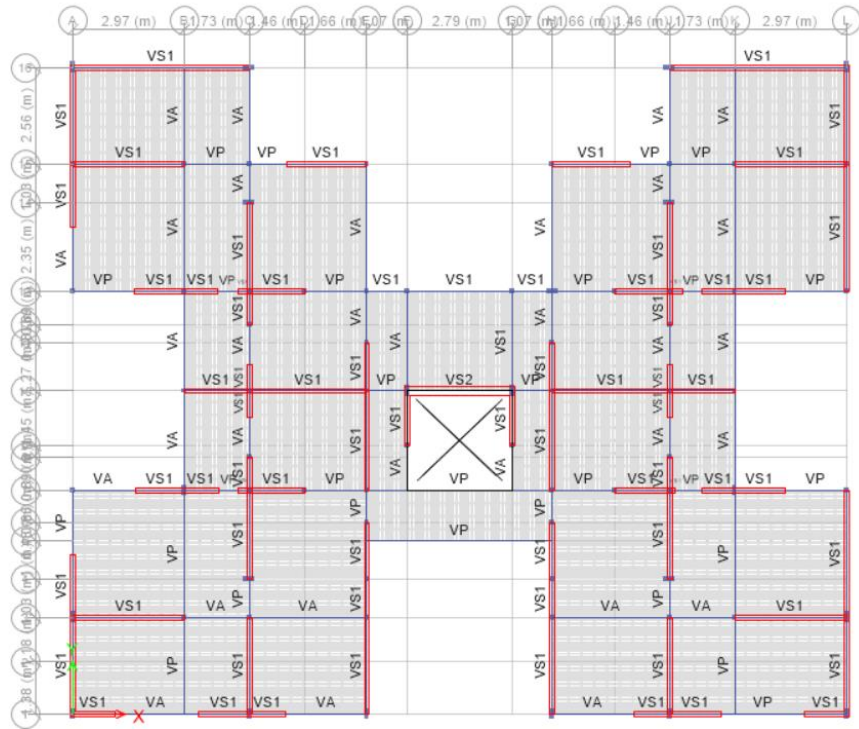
Vista de la planta típica de la vivienda multifamiliar
